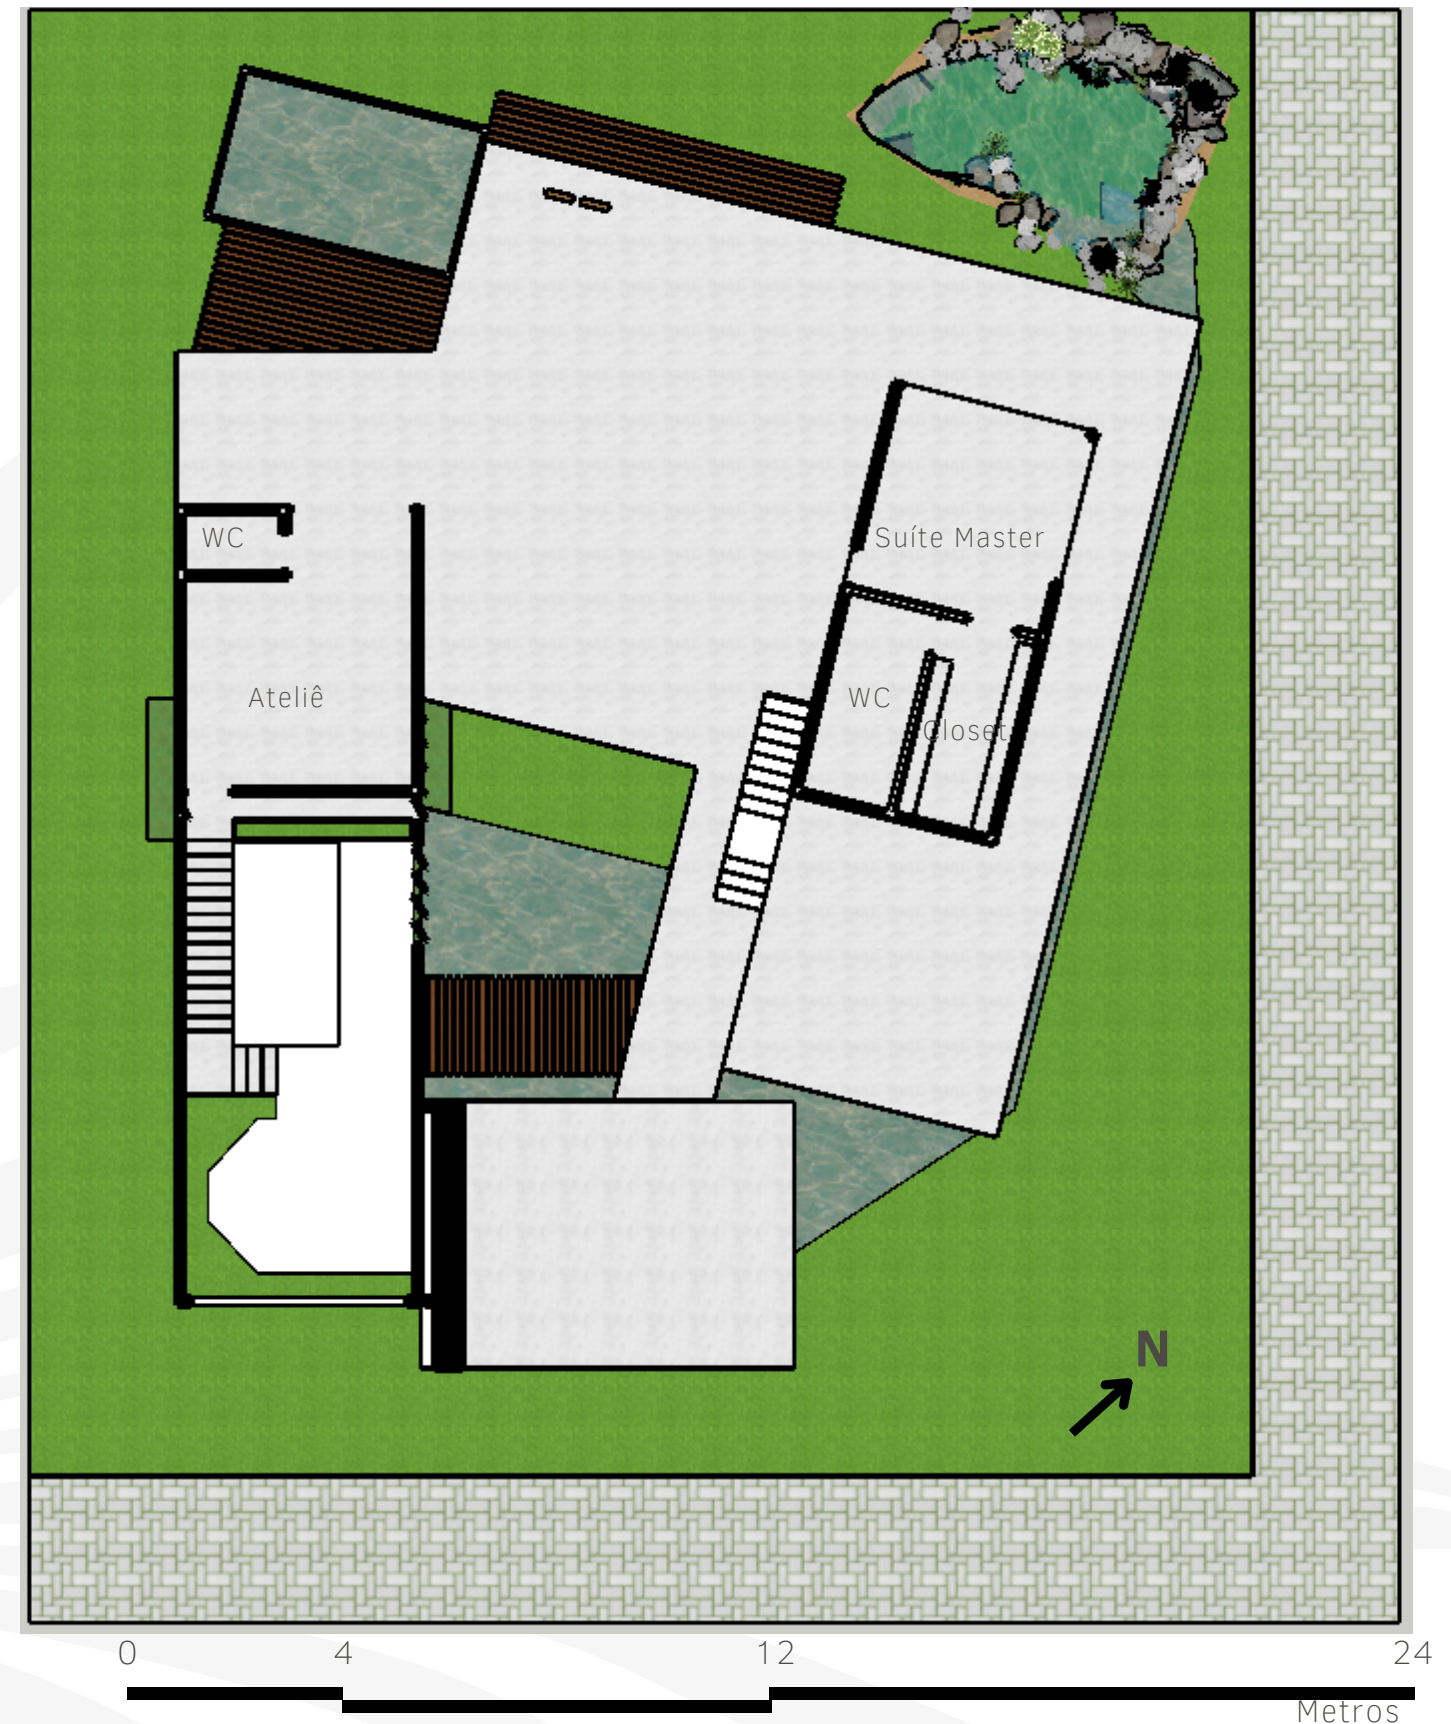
Planta baixa do primeiro pavimento da proposta. Fonte: Elaboração própria da autora.
